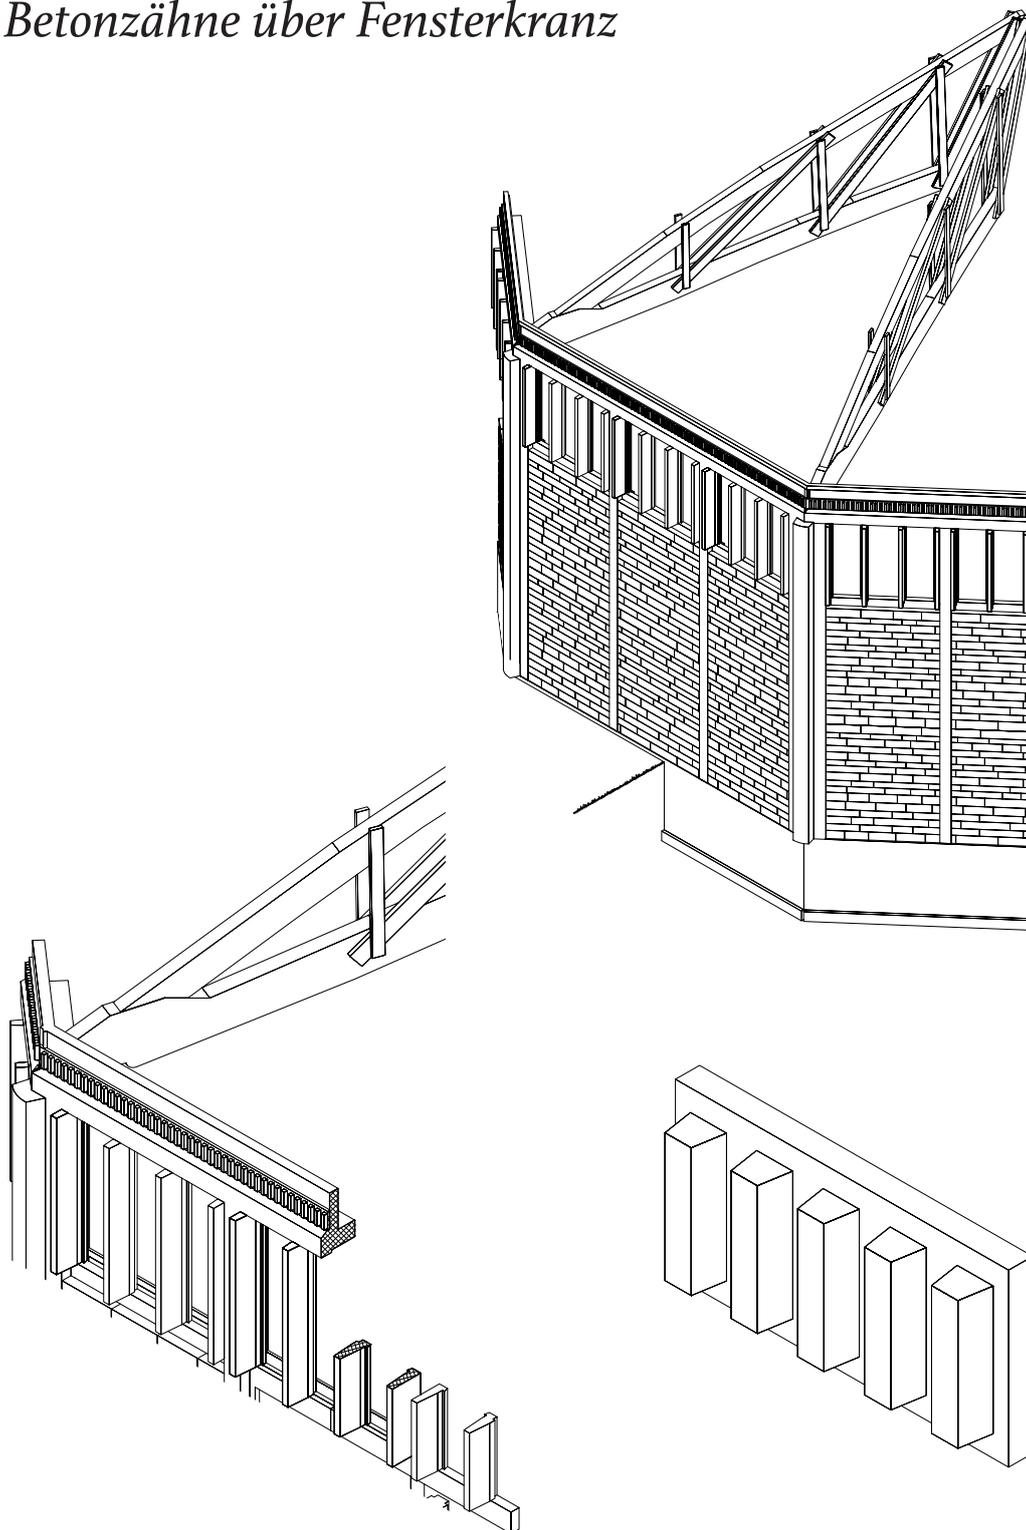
Die Betonzähne zwischen Fensterkranz und Dachgesims wurden in vorfabrizierten Betonstücken à 60cm verbaut
